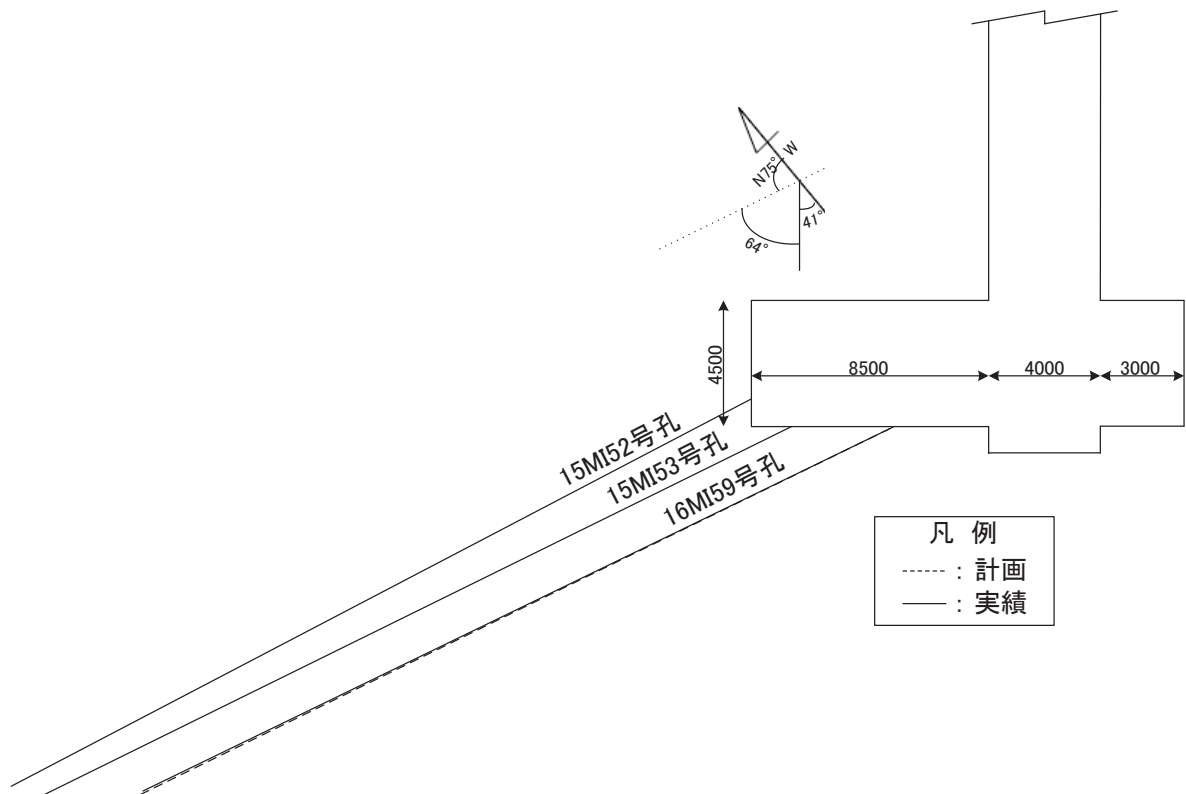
16MI59号孔ボーリング孔跡平面図
